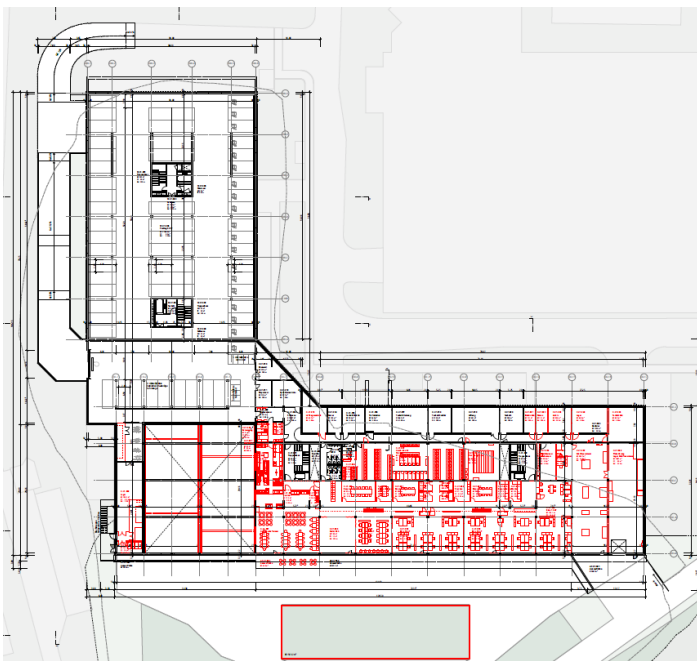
Grundriss UG1 (Quelle: Bauspektrum AG).
